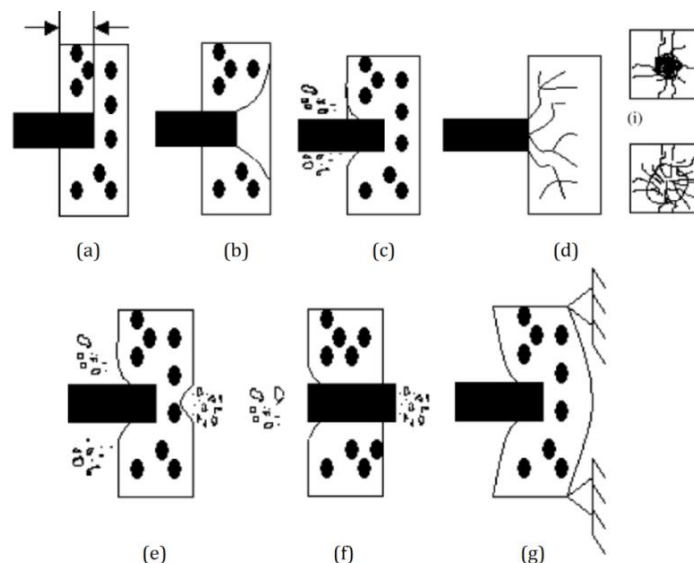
Effets d'impact sur la dalle en béton armé, (a) Pénétration, (b) Fissuration en cône, (c) Cratérisation, (d) Fissuration radiale sur : i) face avant et ii) face arrière, (e) Ecaillage, (f) Perforation, (g) Réponse globale de la cible, [Kennedy, 1976]
